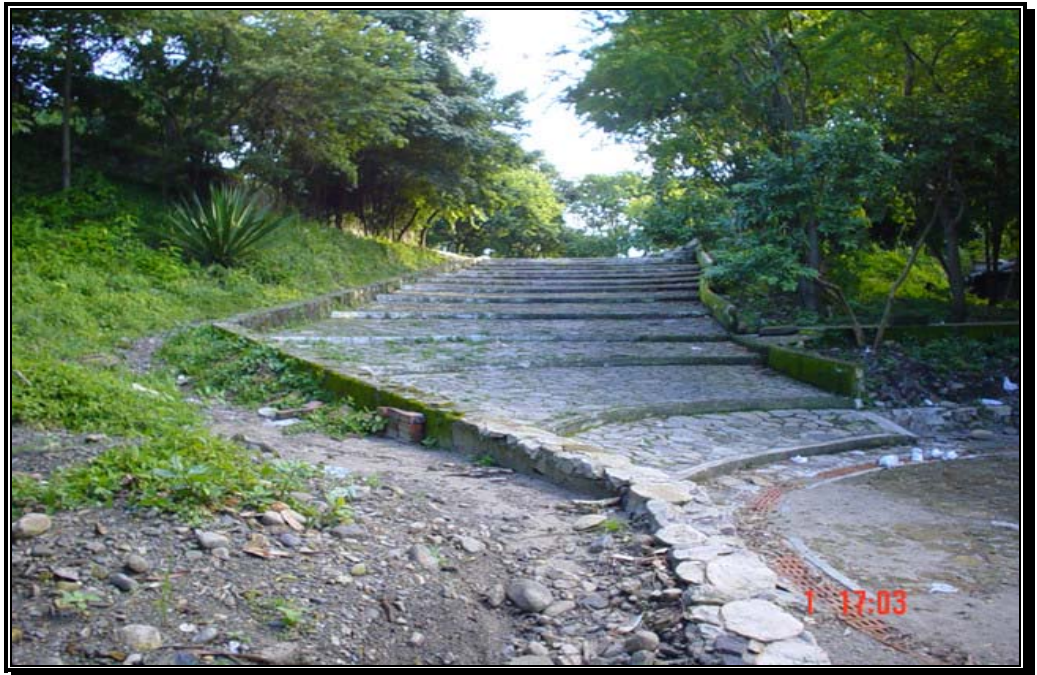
Canales de drenaje en piedra concreto para evacuar las aguas lluvias de Yopal y construidos en el Parque de La Iguana.
